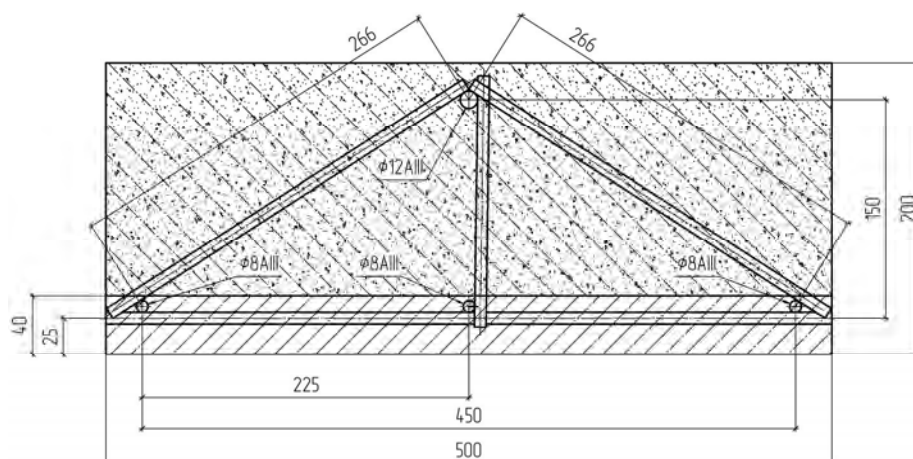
Поперечний переріз короткої збірно-монолітної залізобетонної плити перекриття з використанням пінобетону
